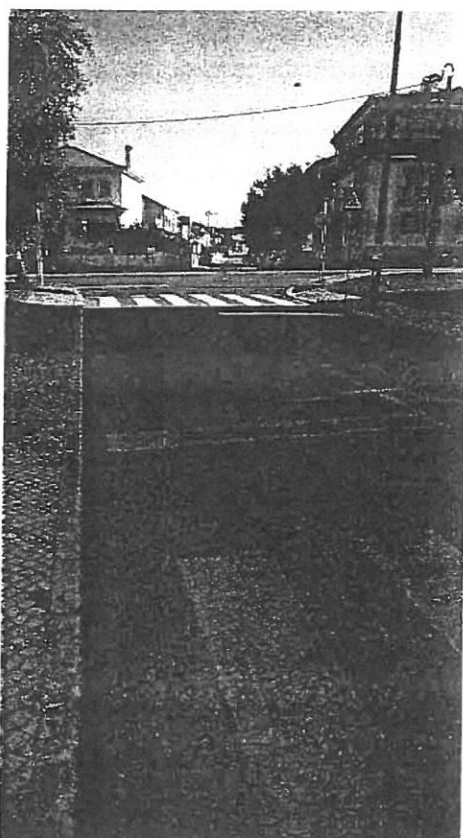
Passadeira início Rua Primeiro de Novembro - Aires
